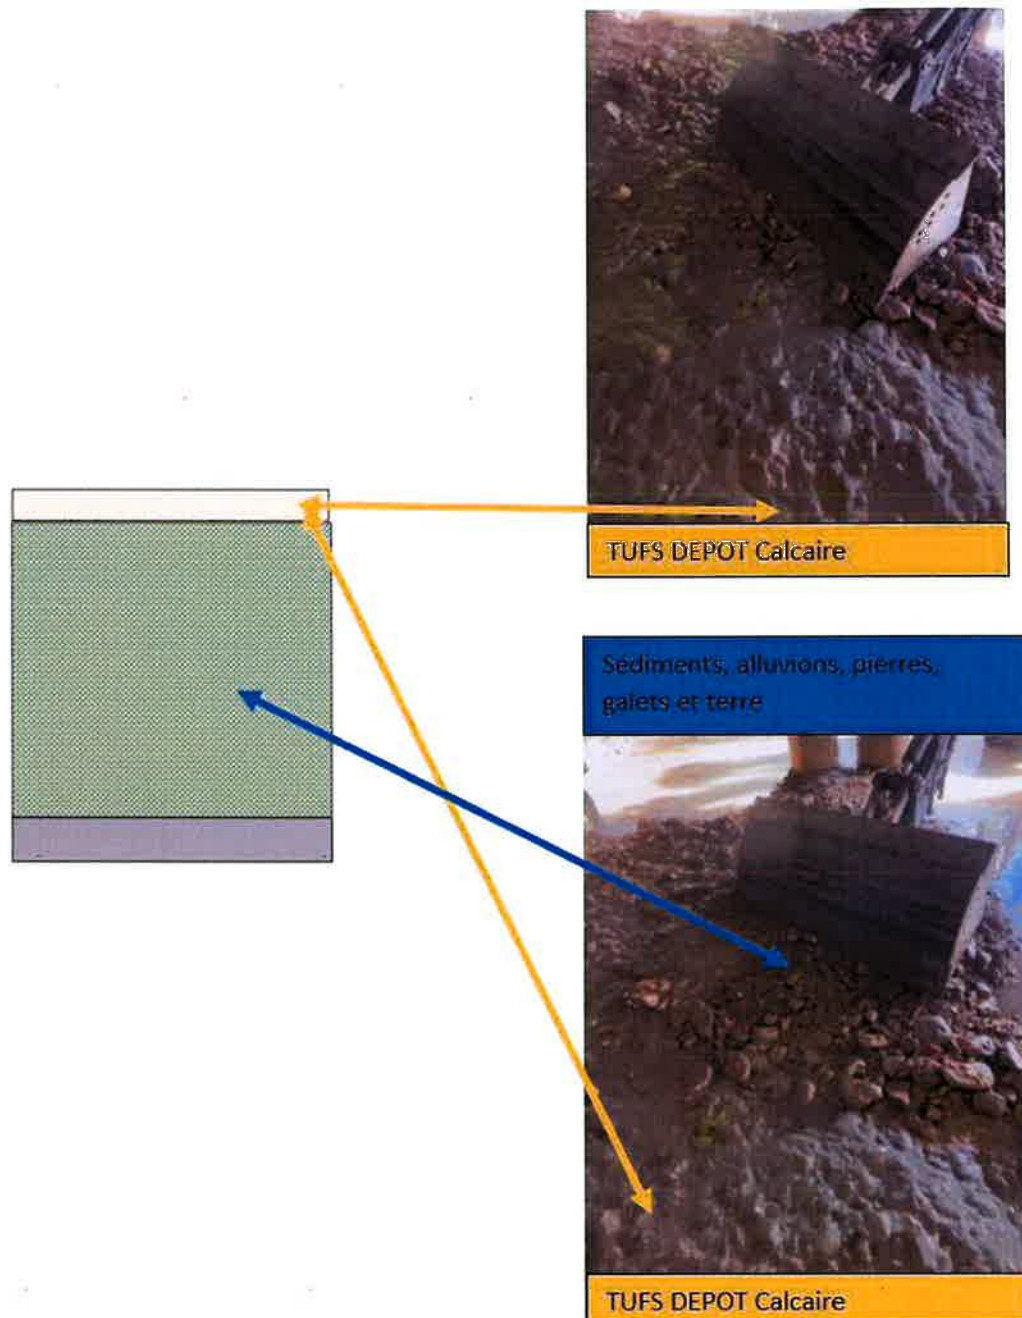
CONSTAT SUR LA ZONE TESTEE – SOURCE : RAPPORT DES TRAVAUX D'ESSAI DE CURAGE DU LAS
